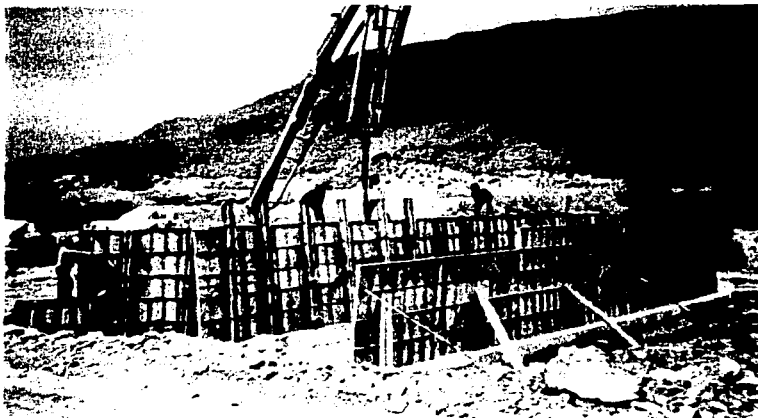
Construcción de muro de cabeza para tubo doble de concreto.
